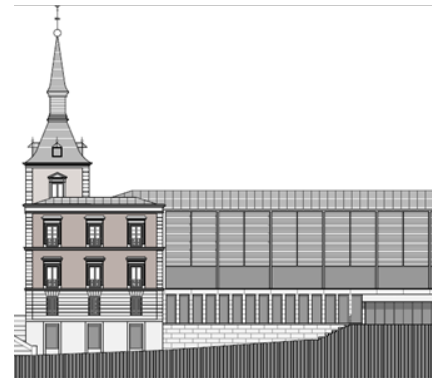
Alzado sur de la propuesta de Cruz y Ortiz
